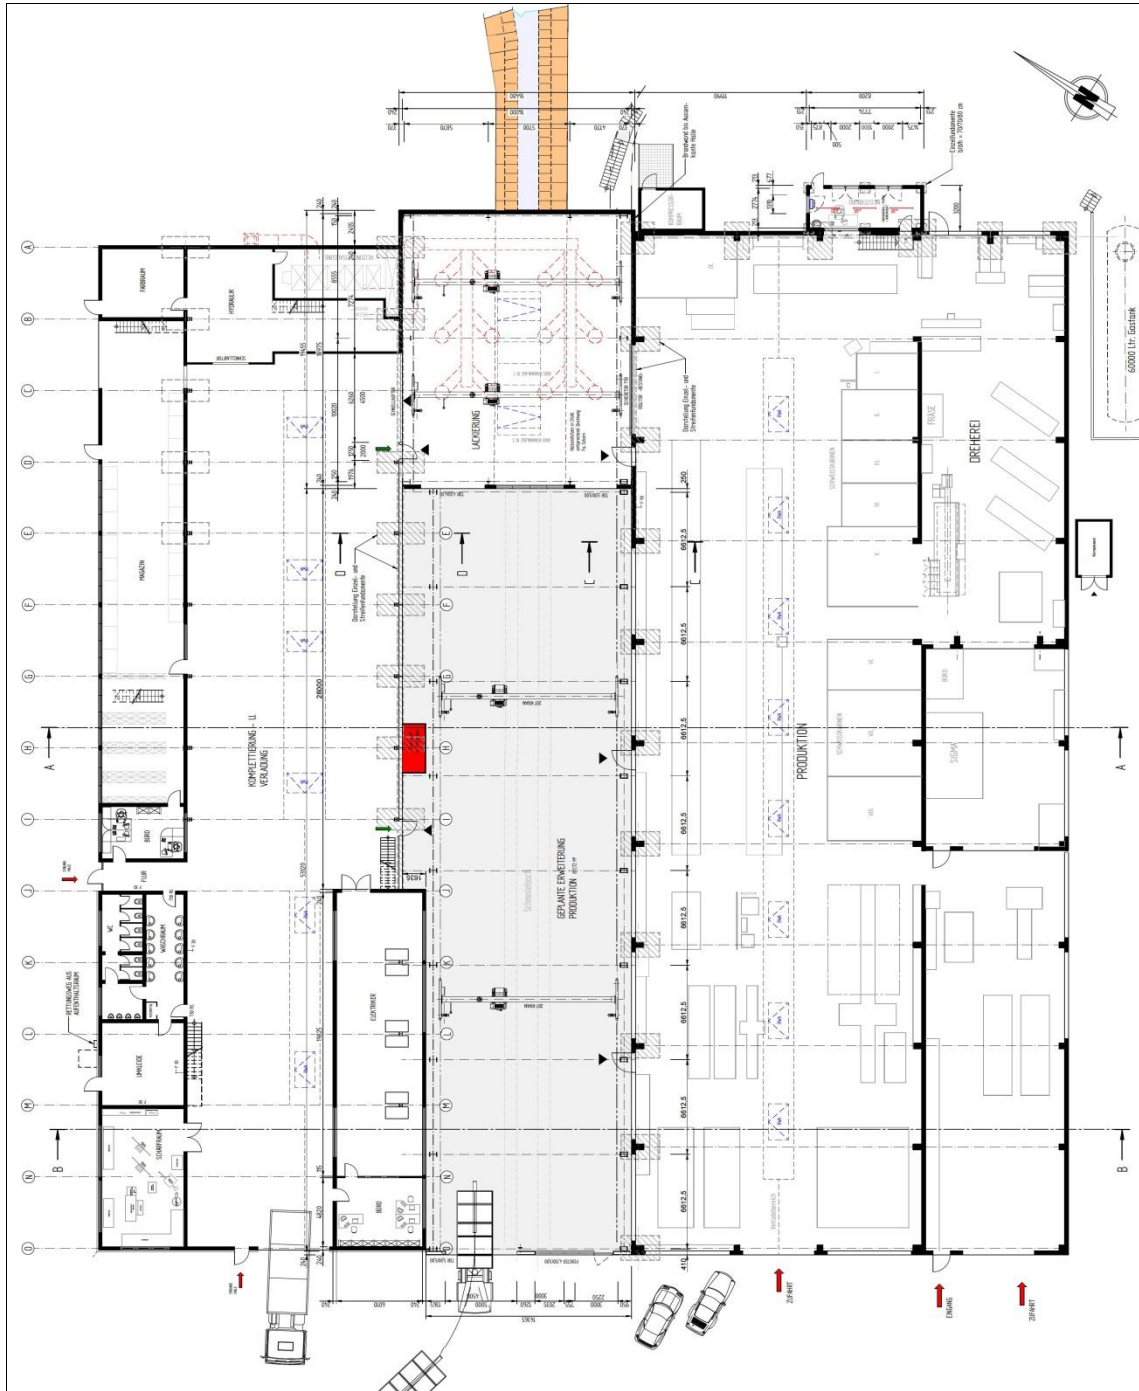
Grundrissplan der Firma HOLTEC (aus [23])
